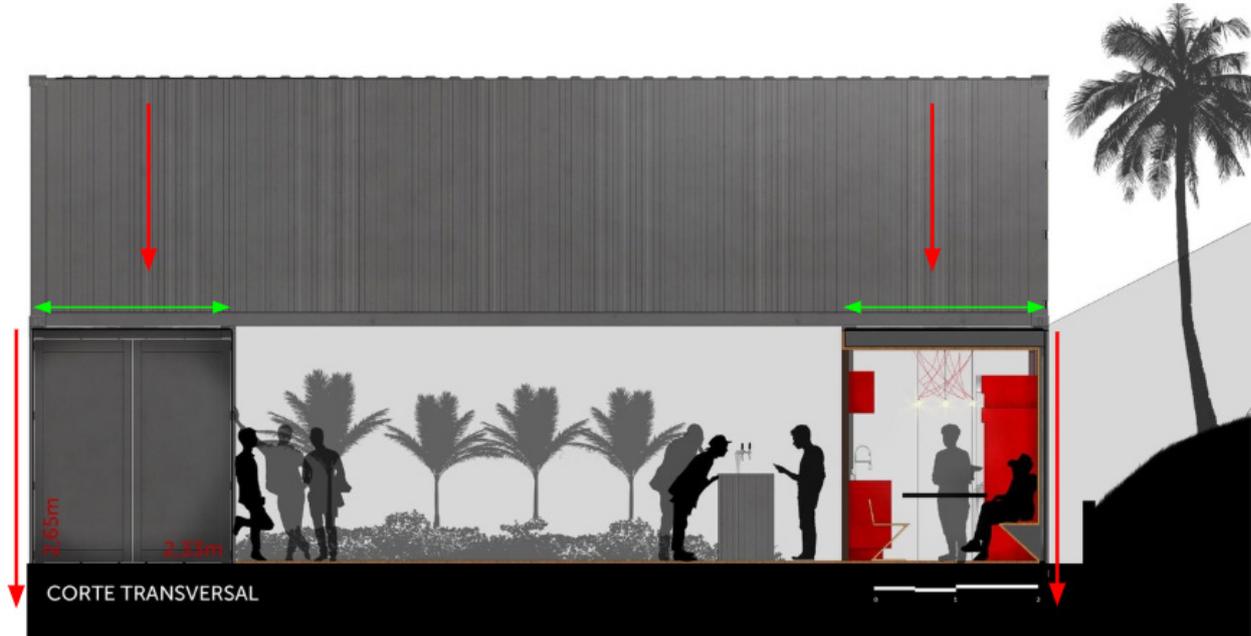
Corte transversal de Restaurante Container. Elaboración propia en base a plano obtenido de "Restaurante Container / MEIUS Arquitectura" ArchDaily Colombia, 6 de febrero de 2019. <<https://www.archdaily.co/co/910744/restaurante-container-meius-arquitectura-plus-bernardo-horta-arquiteto-plus-zargos-arquitectos>> Consultado el 25 de septiembre de 2024.
